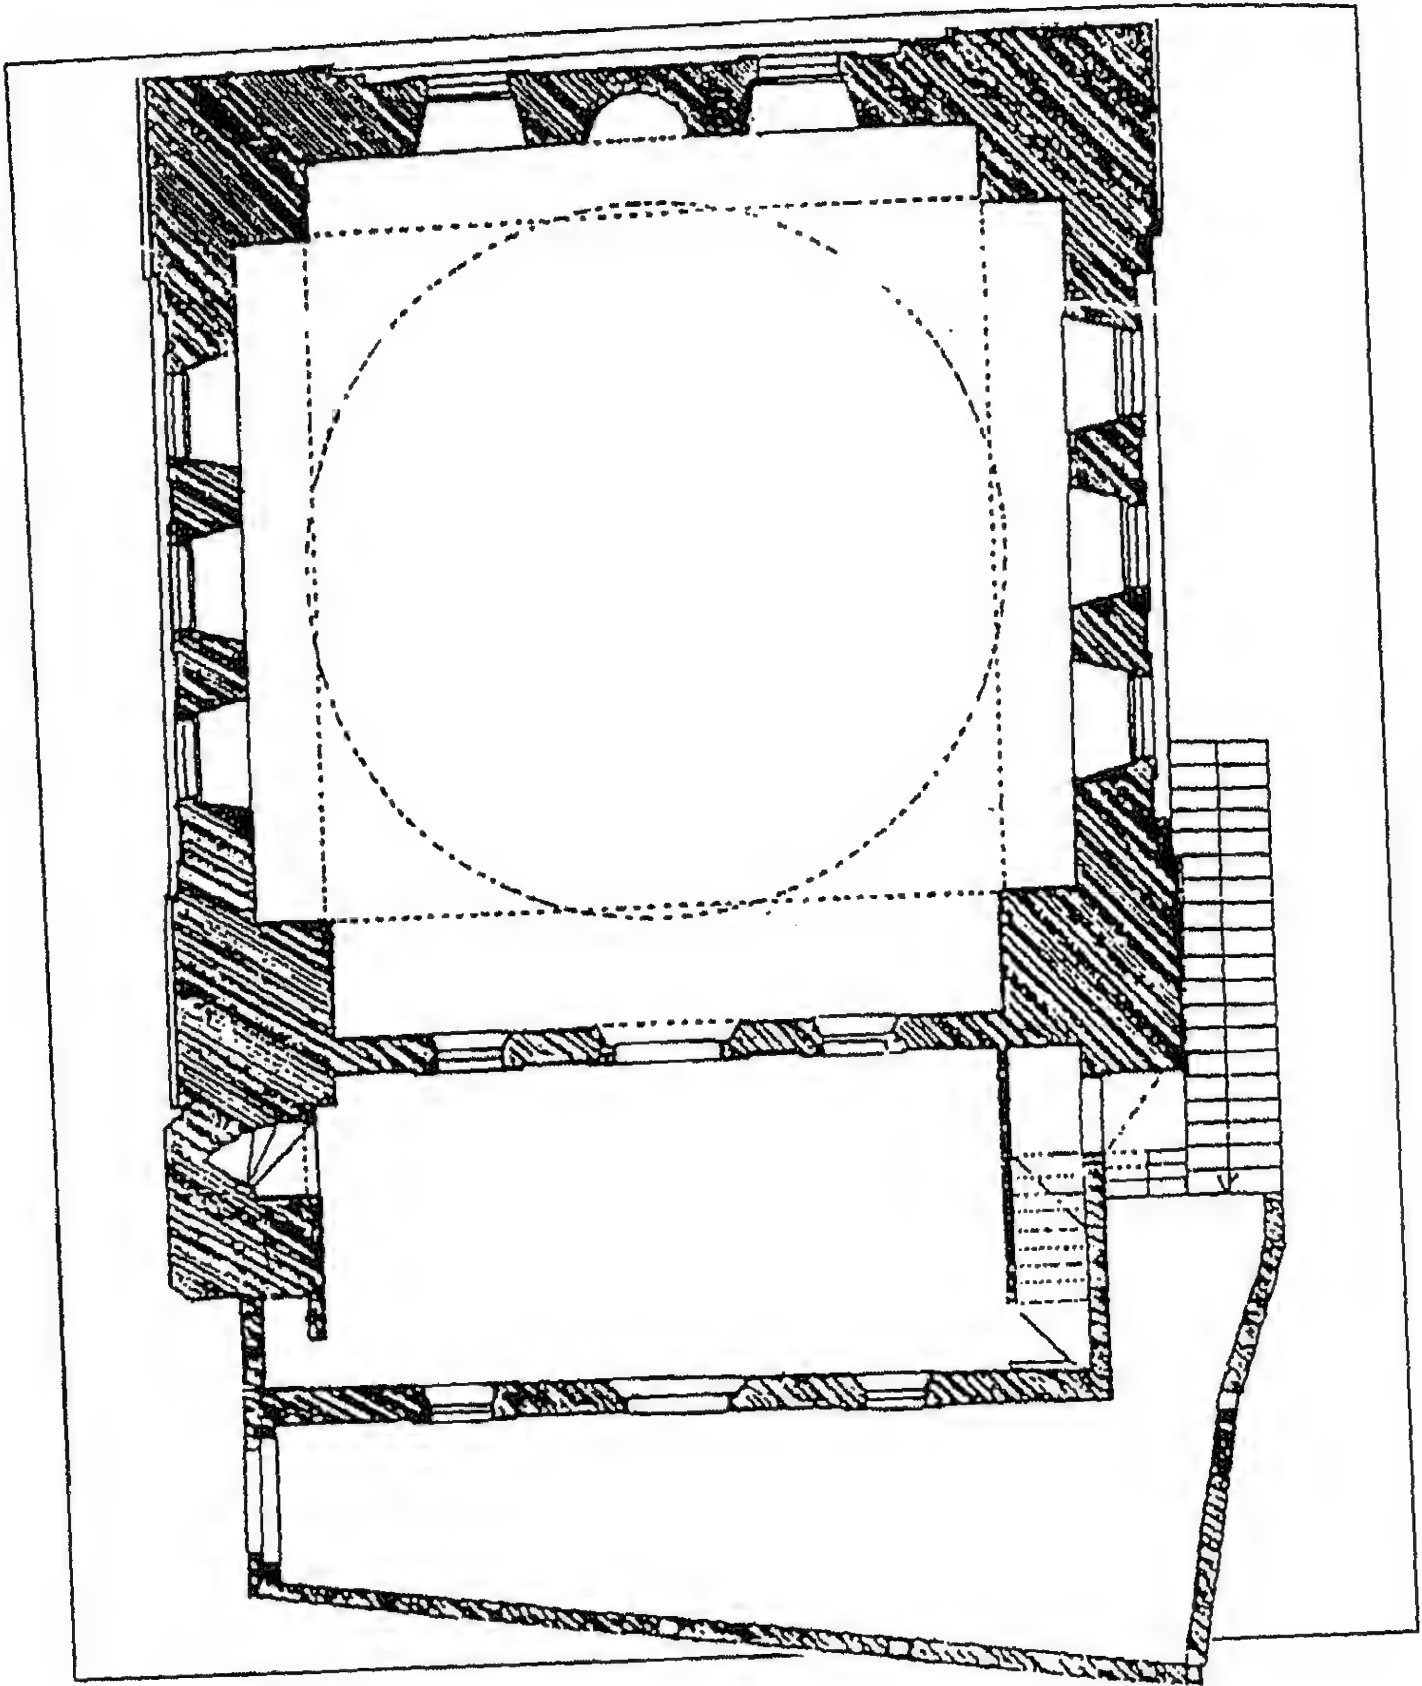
مكرر) مسقط أفقي لتربة حاجي سلطان في بورصة (عن: Wilde).
